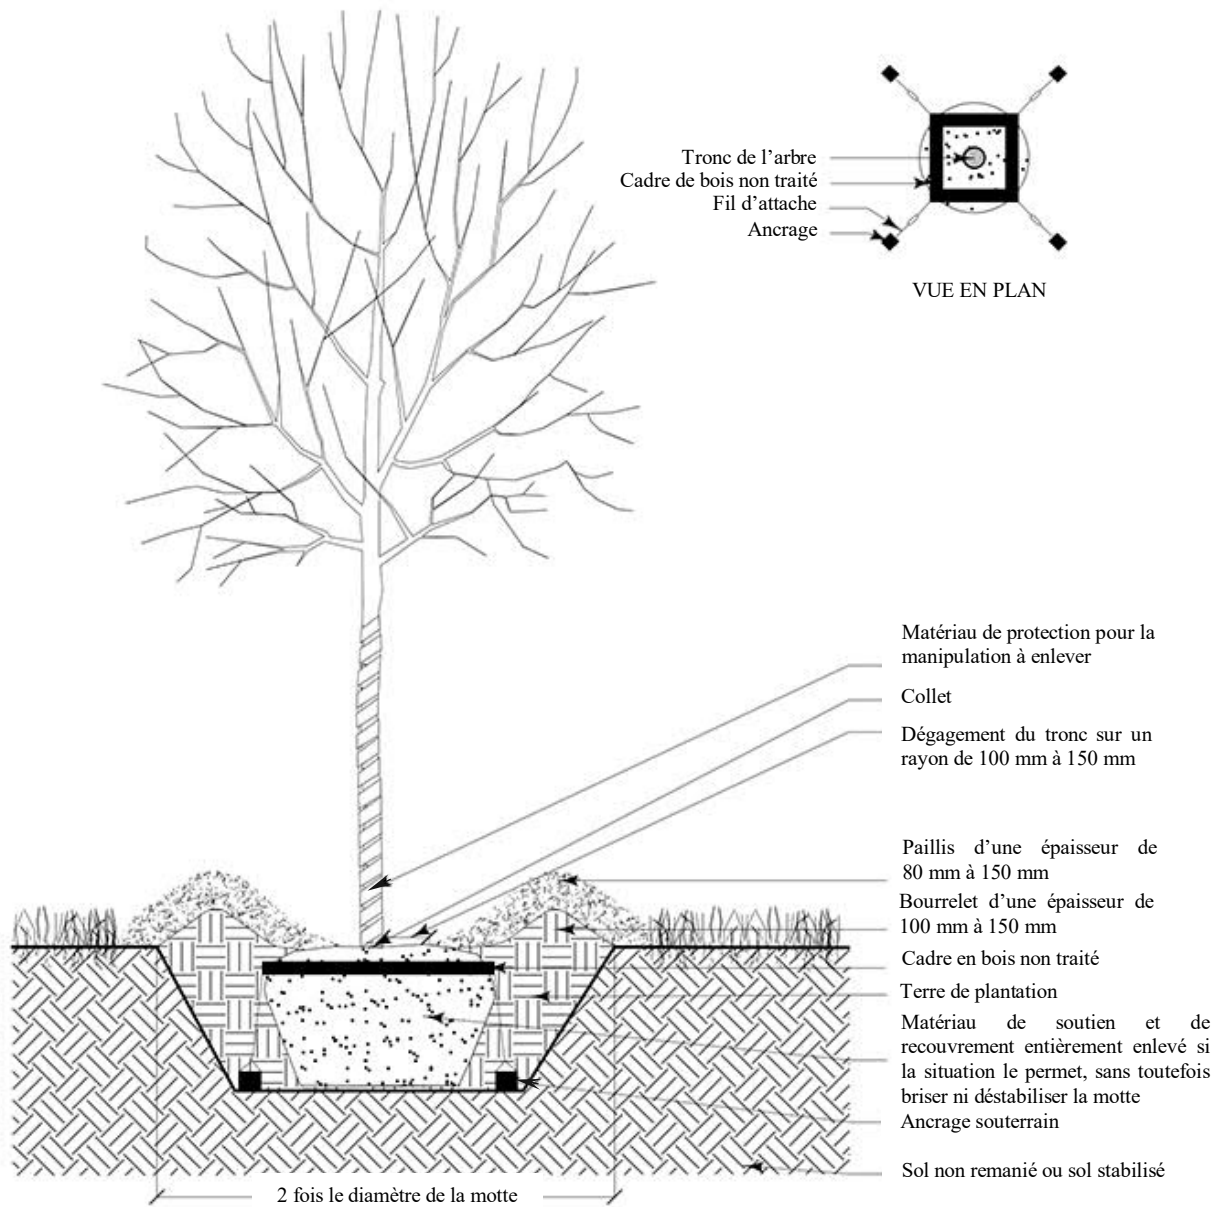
EXEMPLE DE PLANTATION D'UN FEUILLU À L'AIDE D'UN ANCRAGE SOUTERRAIN
